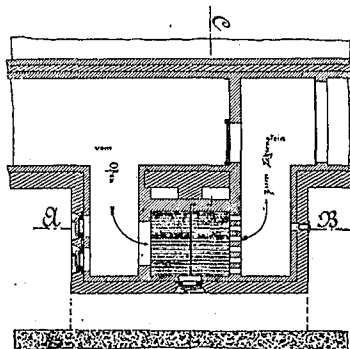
Grundriss i. d. Höhe C-D.
